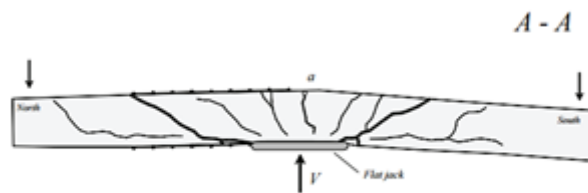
Rotura por punçoamento da laje do ensaio PR1 [2]
